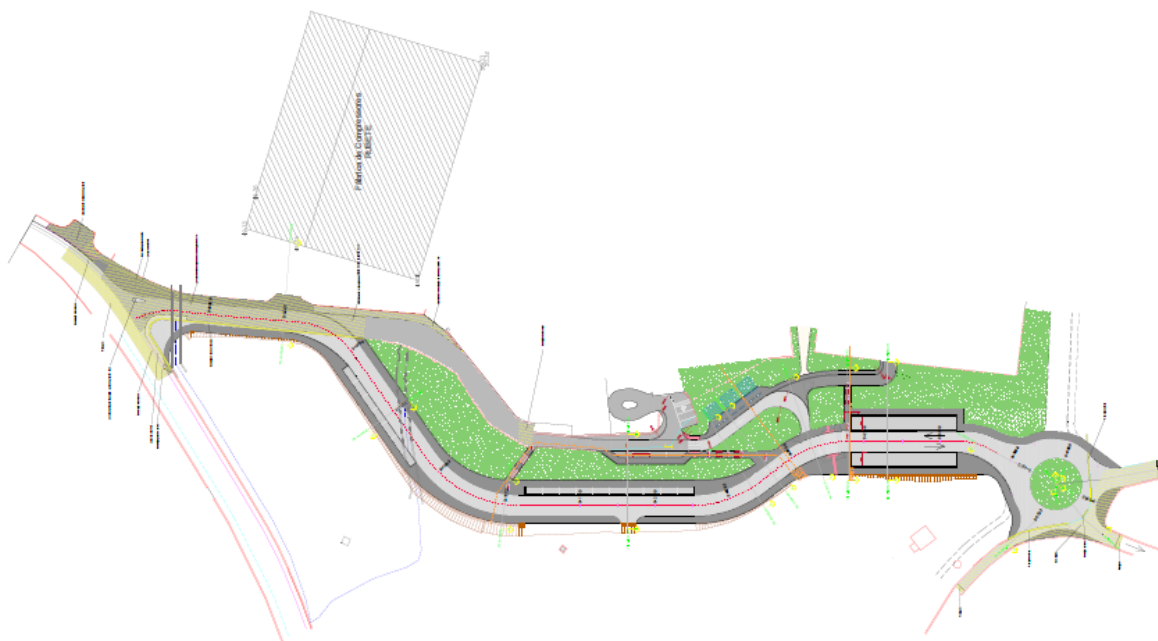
Planta do Traçado de implantação do prolongamento da rua Igreja do Paraíso.
